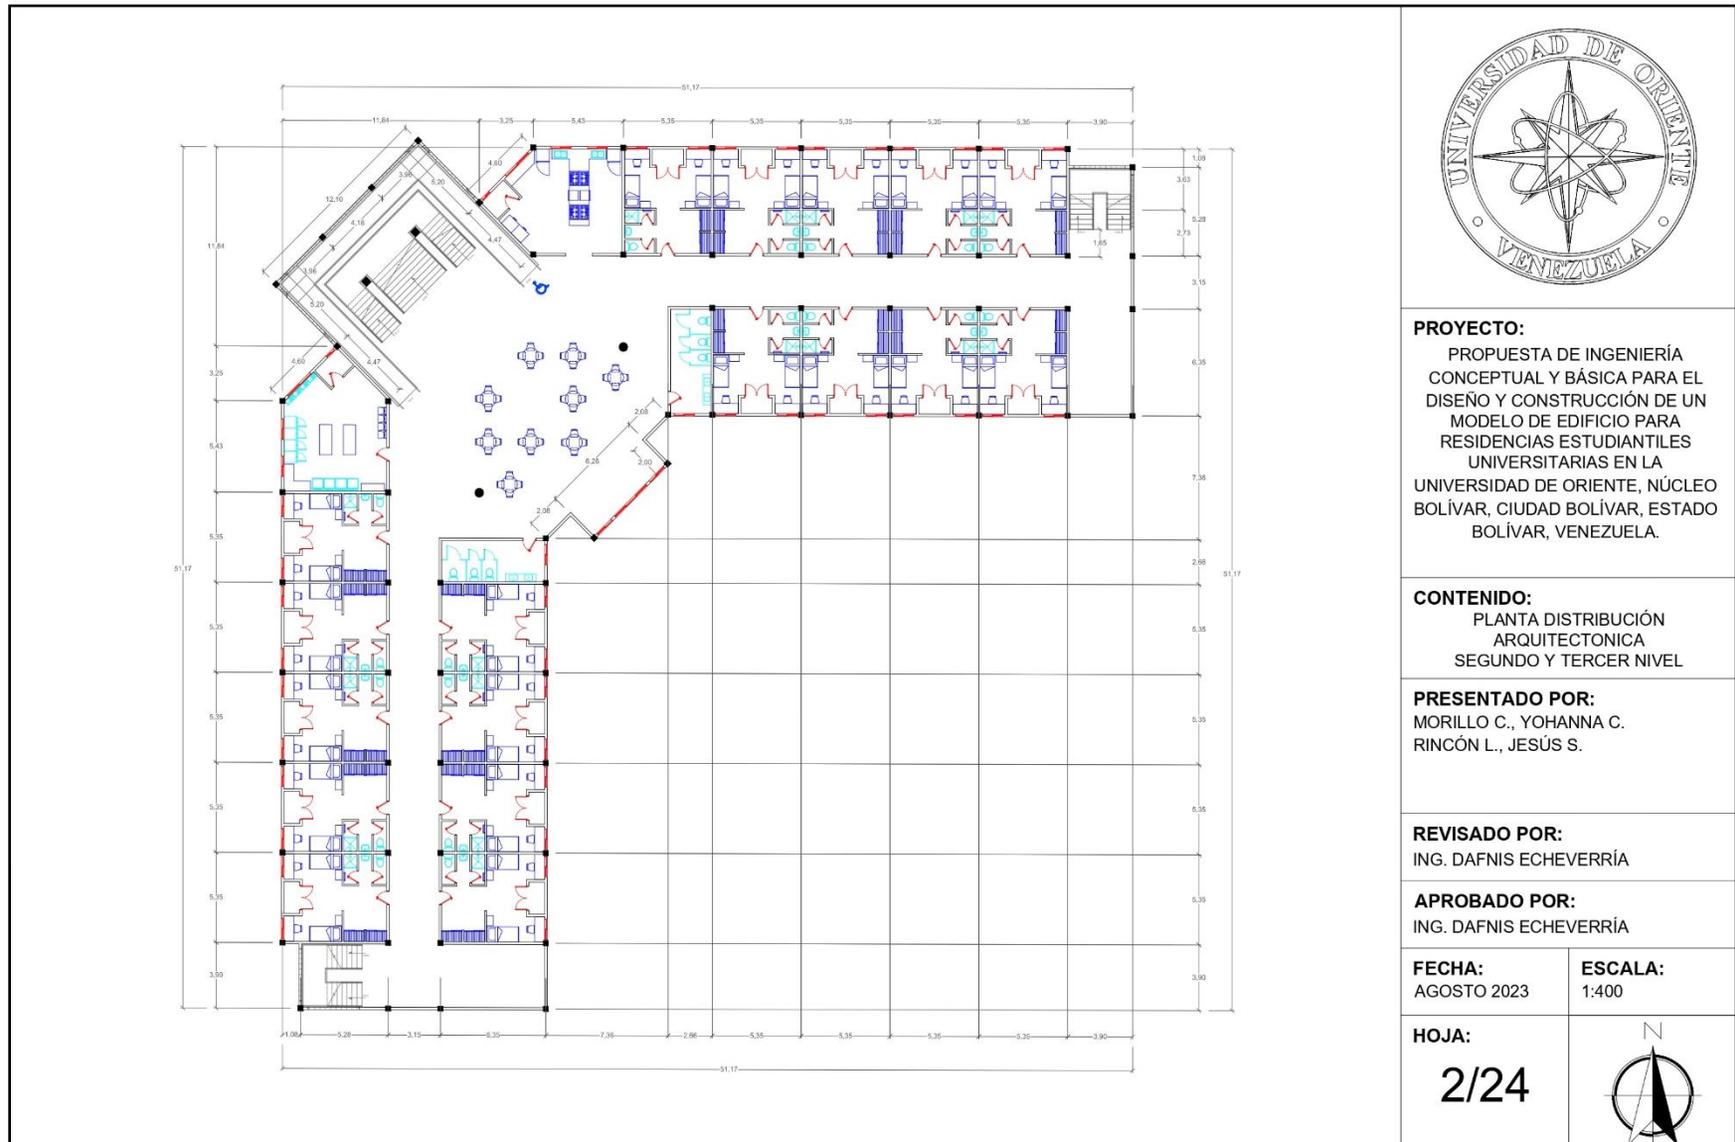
Plano de Planta distribución arquitectónica. Segundo y tercer nivel.
